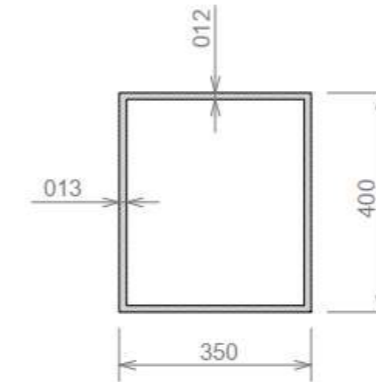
Péndolas utilizadas en la parte de tablero inferior (fuente: elaboración propia)
